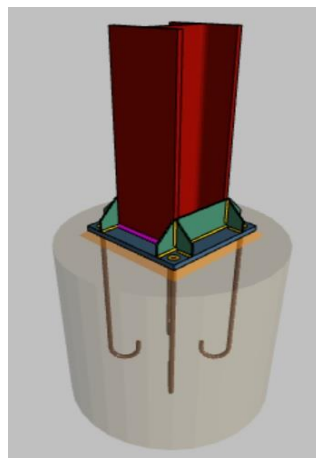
Placas de anclaje. Fuente: CYPE 3D.
